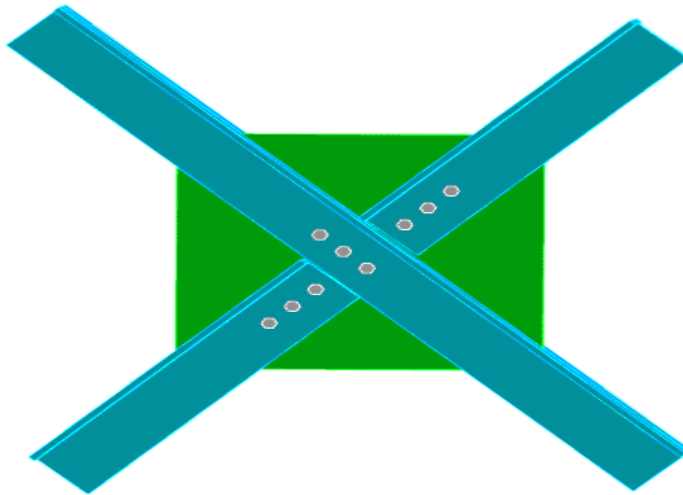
Vue en 3D de l'assemblage au gousset
